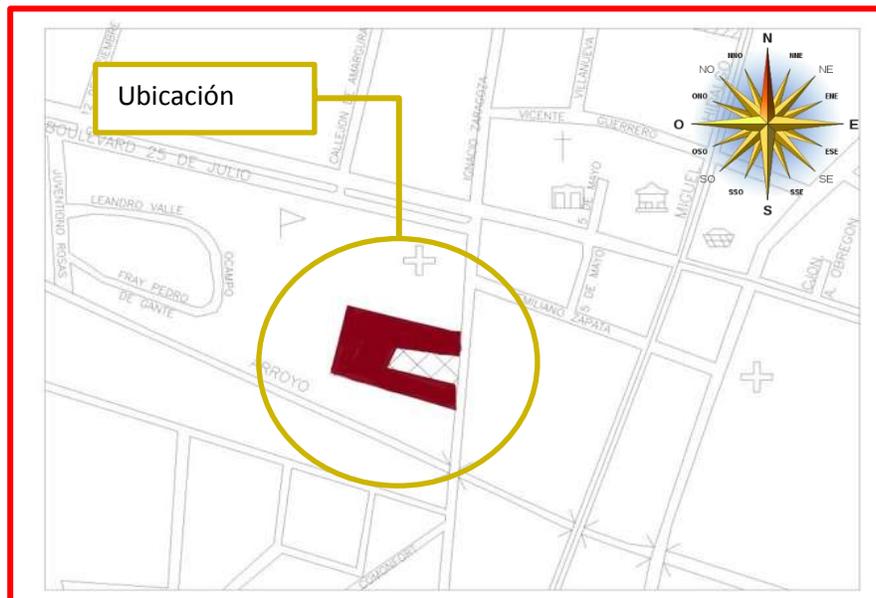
Plano de ubicación en Plano de la Ciudad de Santiago Maravatío/dwg
